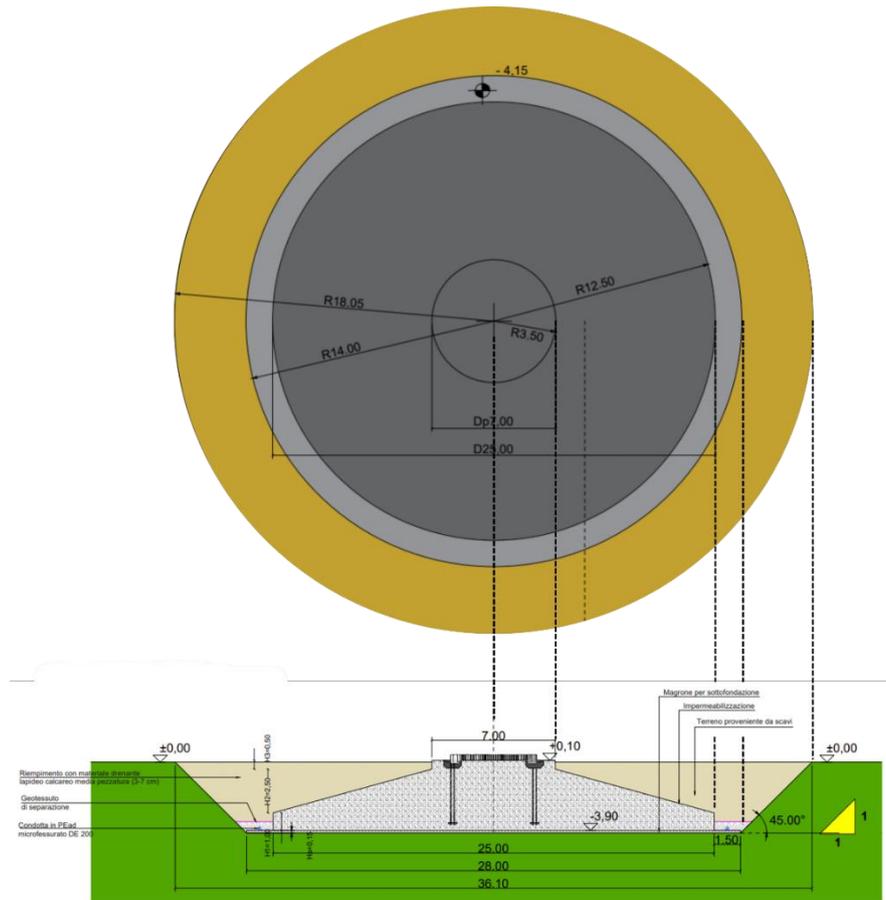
Pianta e vista della fondazione tipo dell'aerogeneratore
